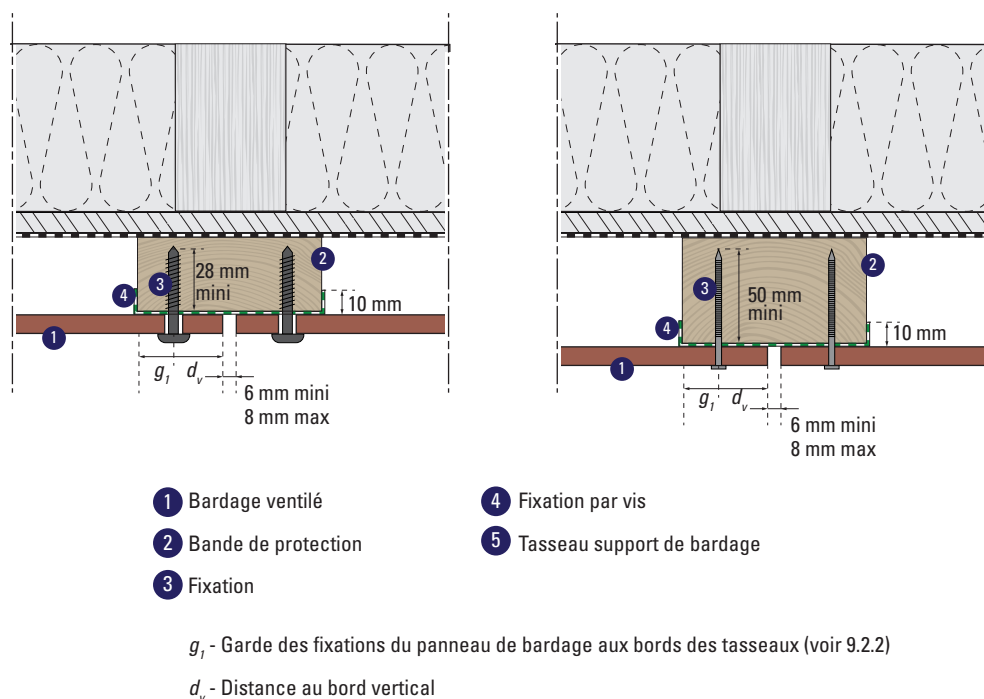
Exemple de traitement des joints verticaux – coupe horizontale
